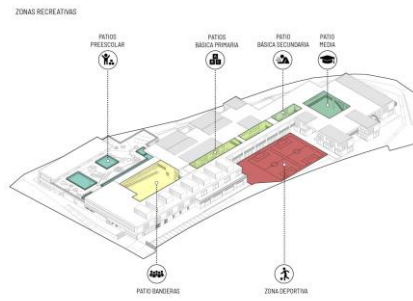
Fuente (Fp Arquitectura, Archdaily, 2019)
